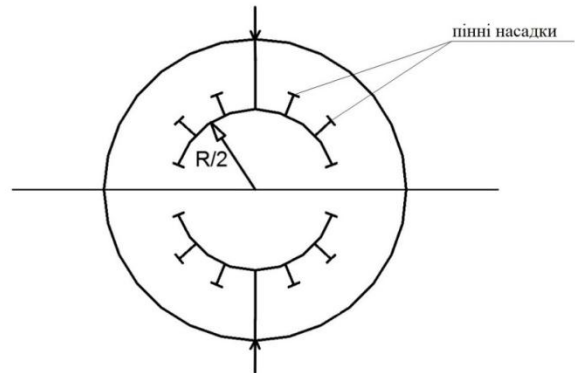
Принципова схема розташування пінних насадок всередині резервуара
